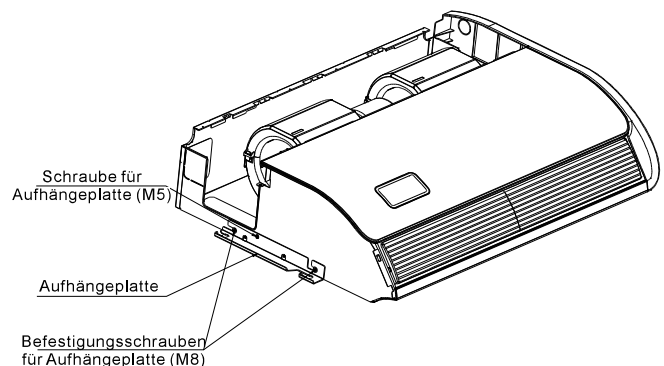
Aufhängungsbolzen und Muttern
